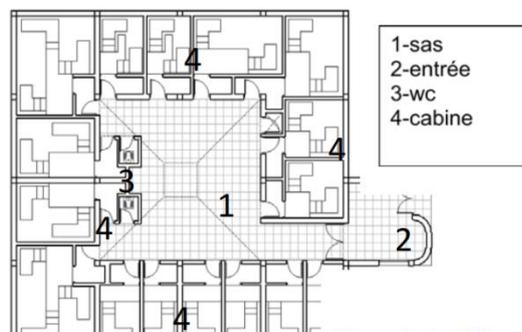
50: Plan du Hammam traditionnel (google image modifier par l'auteur 2019)
